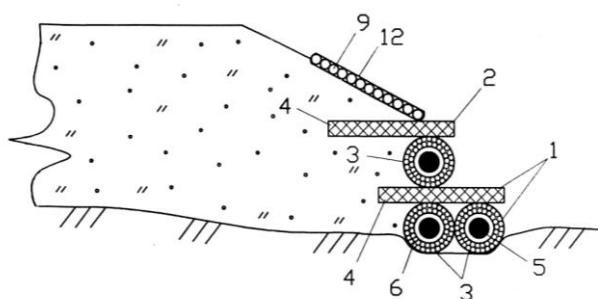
Подпорные стенки биопозитивной конструкции
